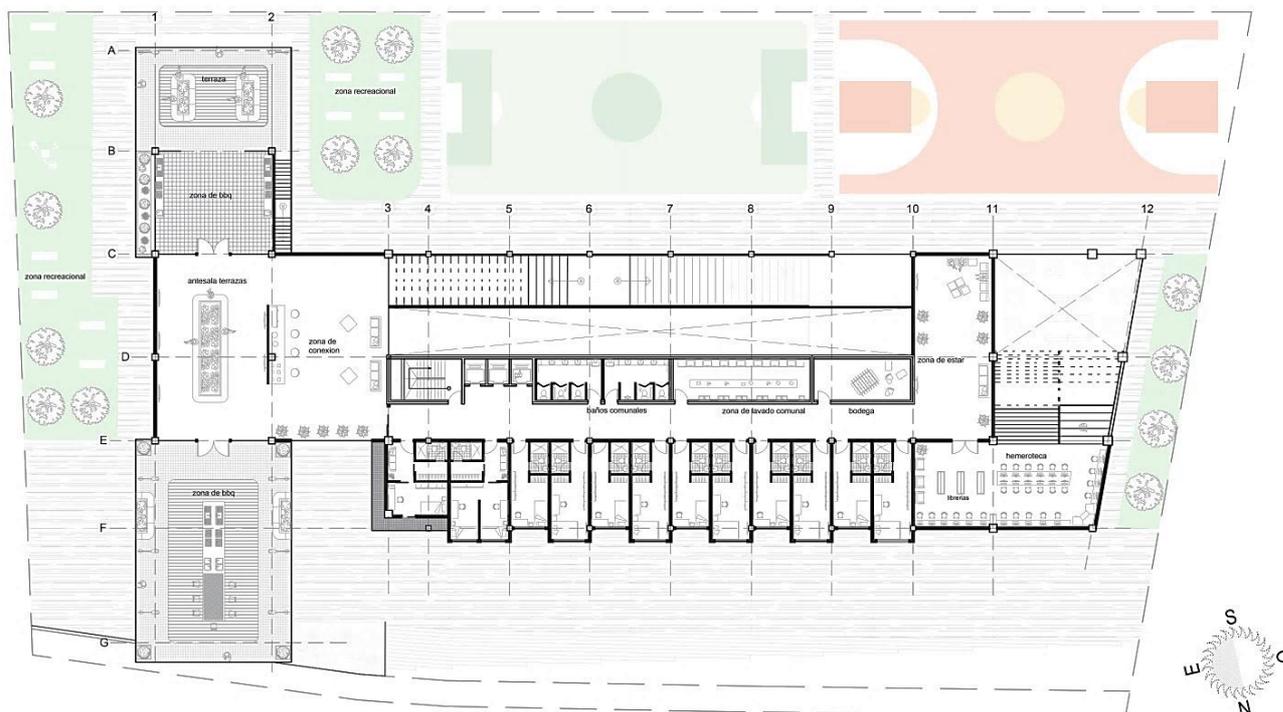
Planta: piso 5 Cevallos. (2018). Creación propia
